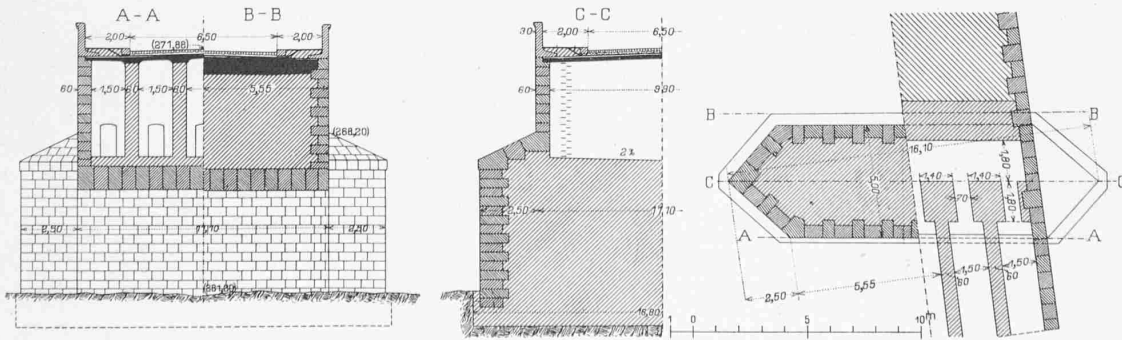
Grundriss, Ansicht und Querschnitte von Pfeiler und Gewölbe der Hauptbrücke. — Masstab 1 : 300.
